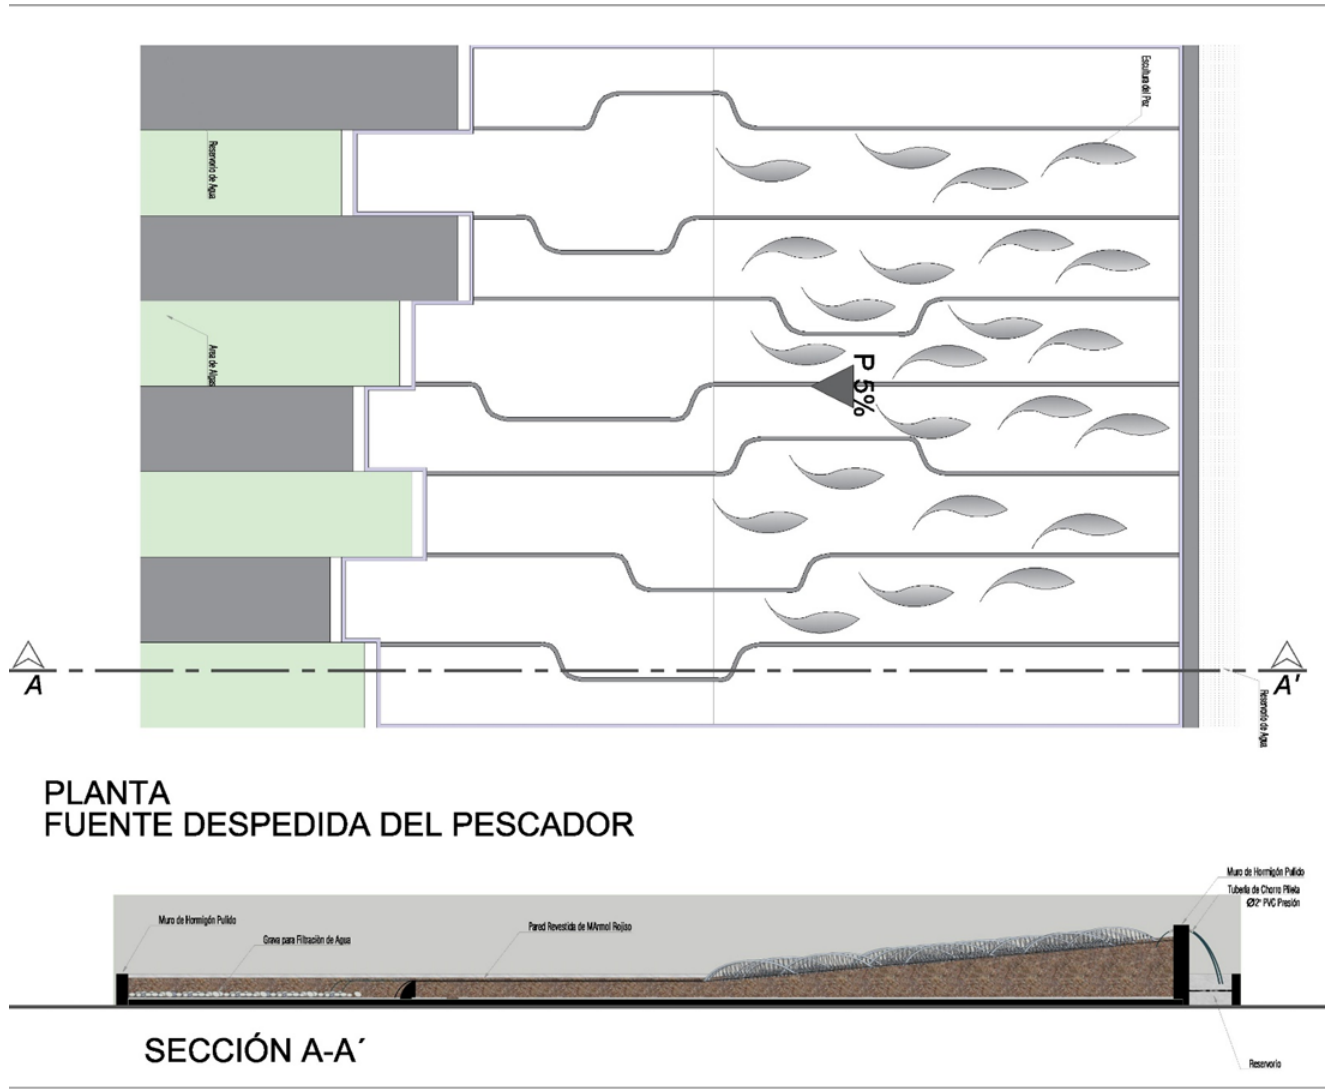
Detalle en Anexo 16. Elaboración: Propia.
